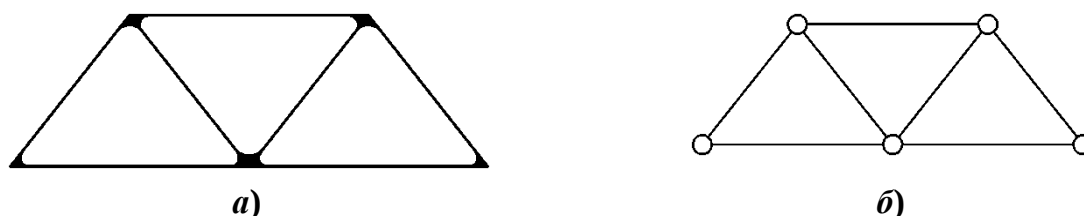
Стержневая конструкция и её расчётная схема в виде фермы
